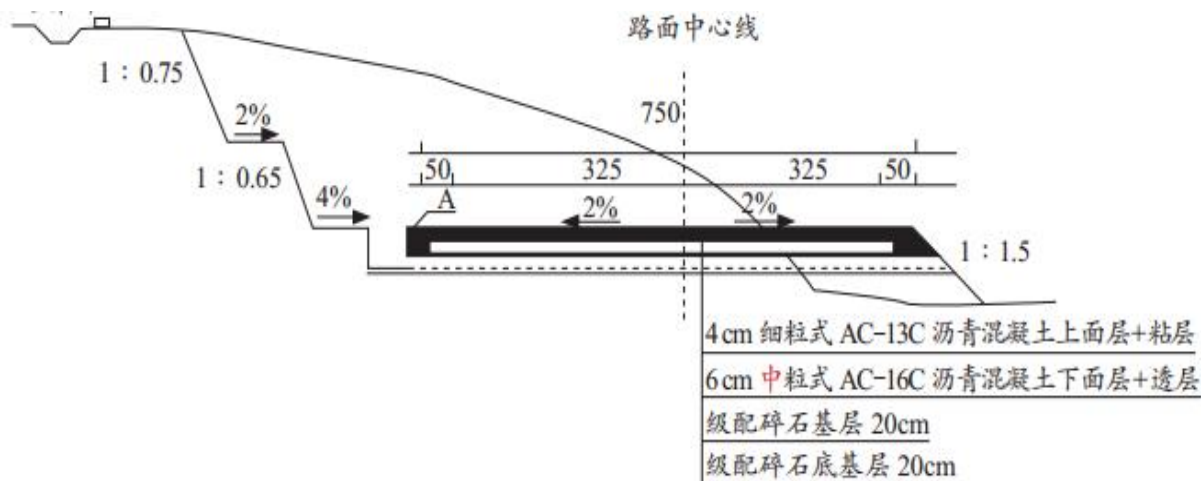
三级公路沥青混凝土路面结构示意图 (单位: cm)
